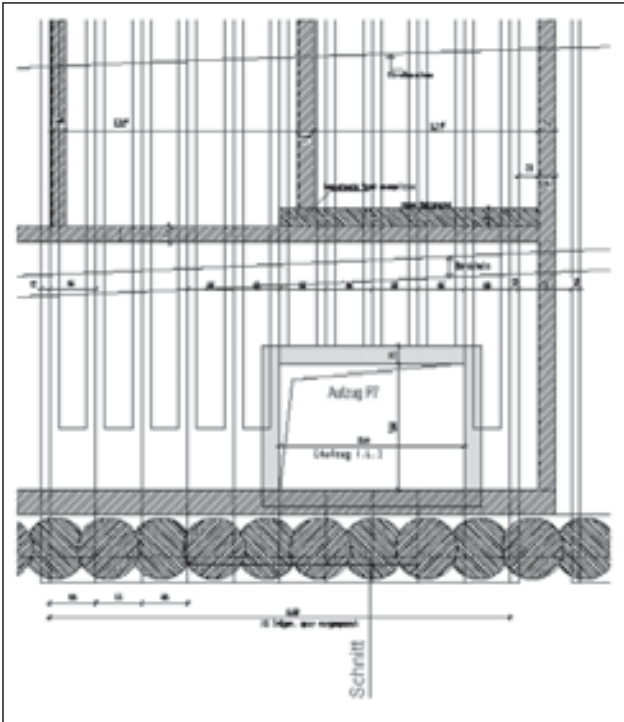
Ansicht des Grundrisses des geplanten nachträglichen Einbaus des Aufzuges
